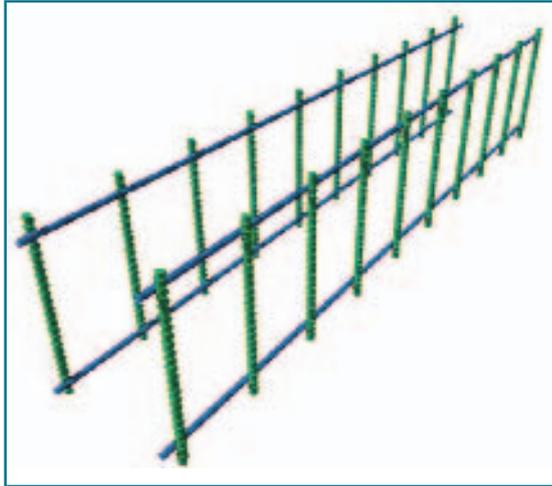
Высокоэффективное комбинированное поперечное армирование в форме лестницы для балок или плит.
